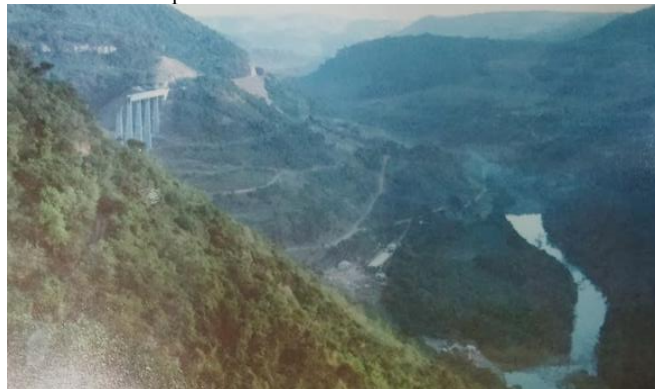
Viaduto 13 em construção com vista para o rio Guaporé
